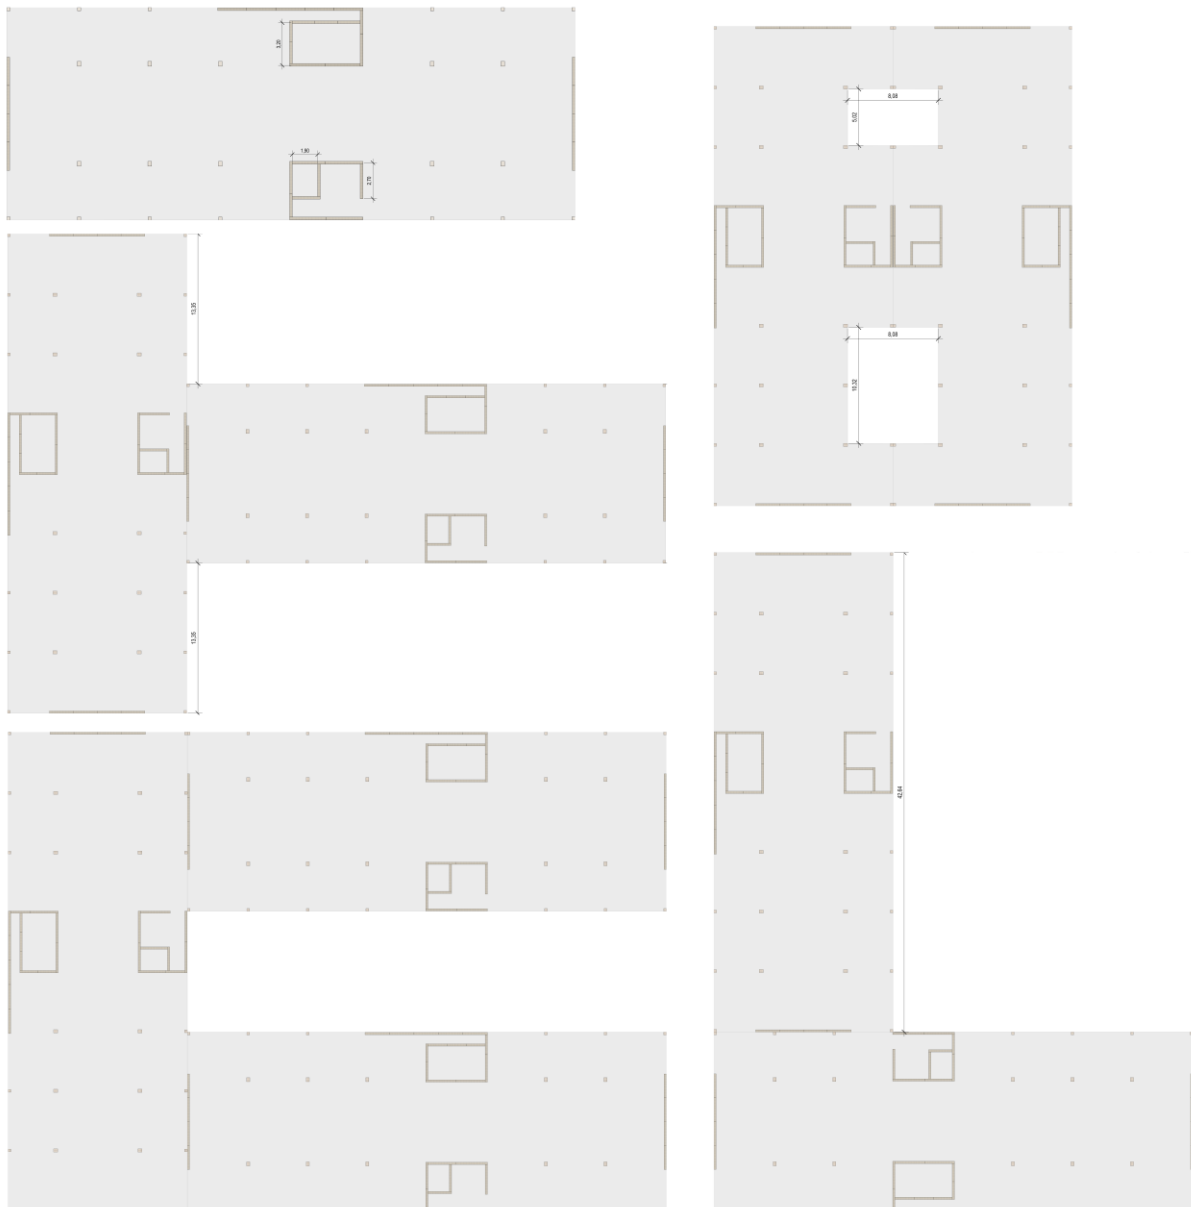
Mögliche Grundrissvarianten für Konzept 2
